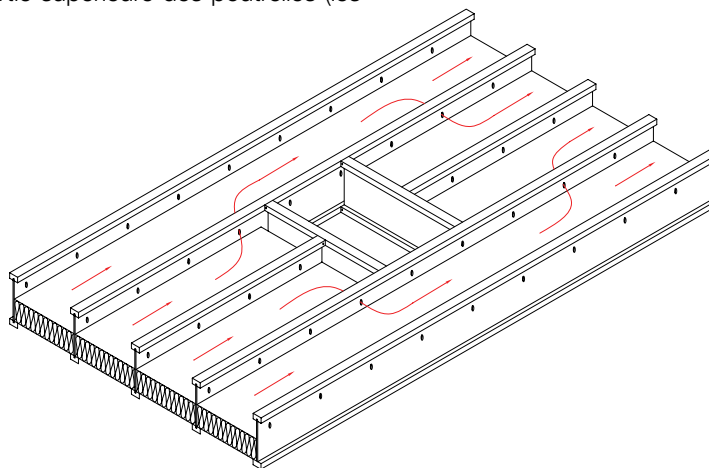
• Ventilation dans un toit en poutrelles de bois en I
